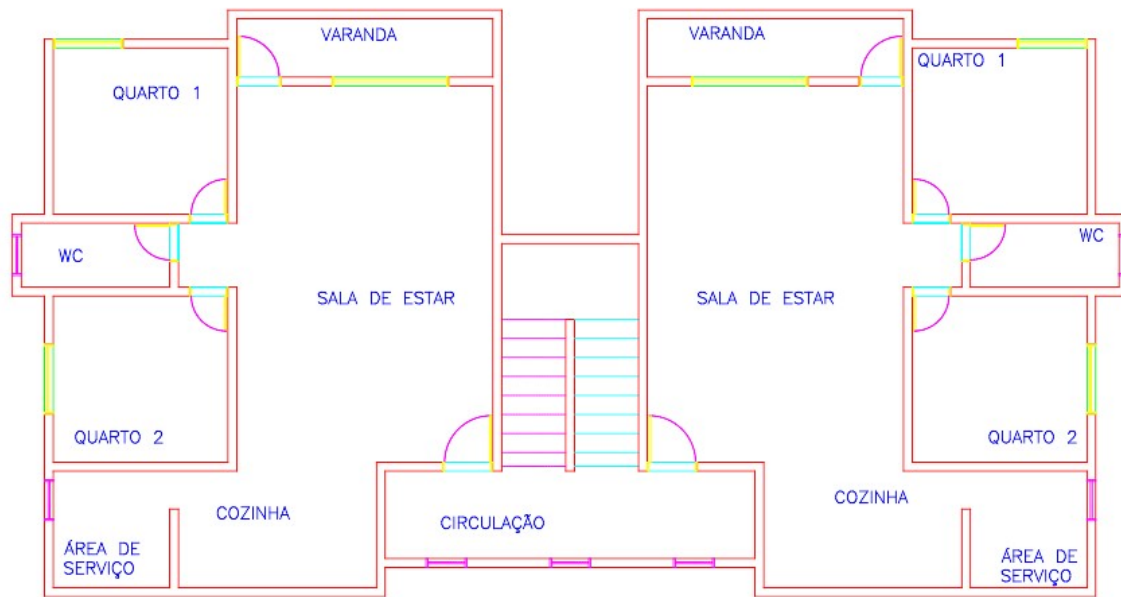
Planta baixa do pavimento tipo do edifício residencial orçado (Fonte: Própria, 2017).
